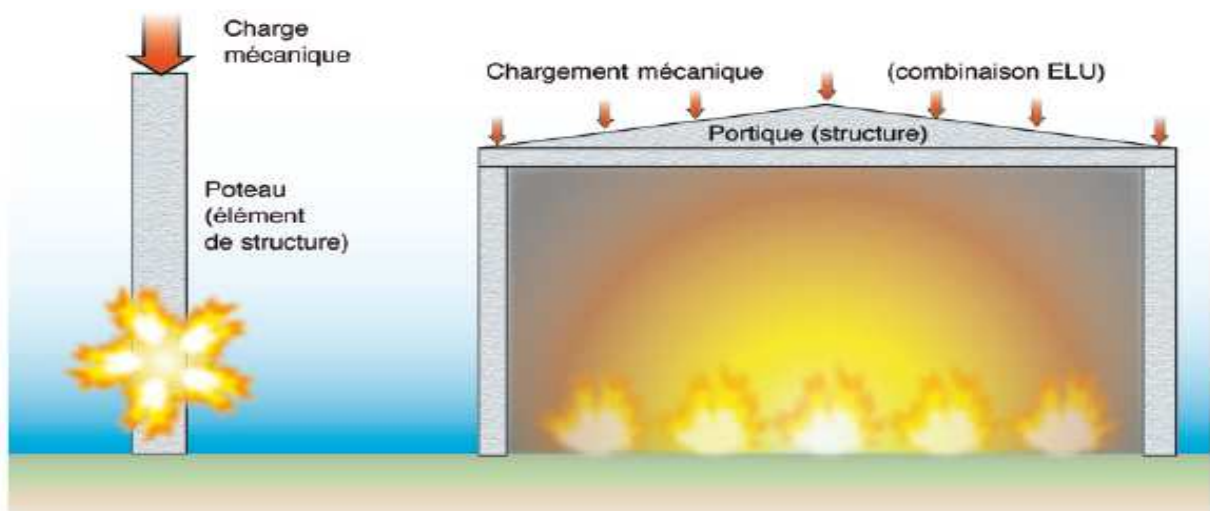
stabilité au feu d'un élément isolé et d'une structure [52]
